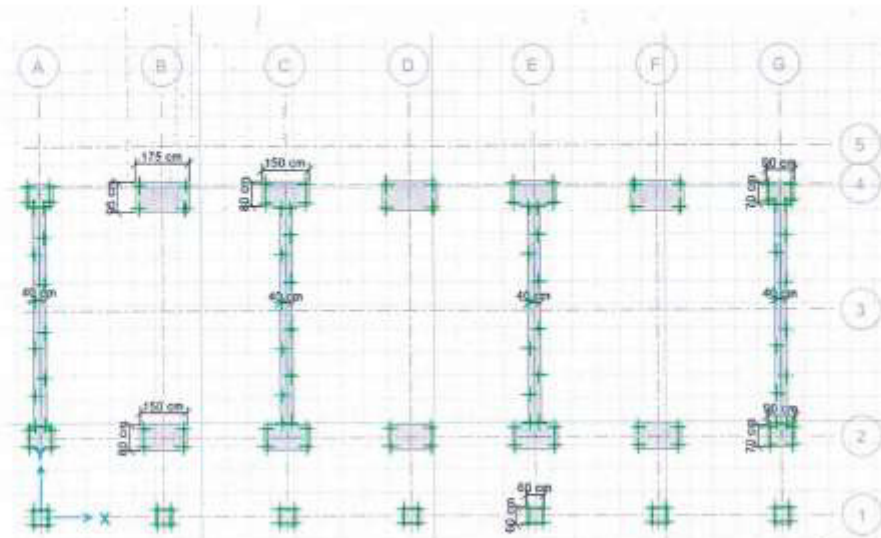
Vista en planta de la cimentación del módulo 3 Aulas / 3 Aulas
